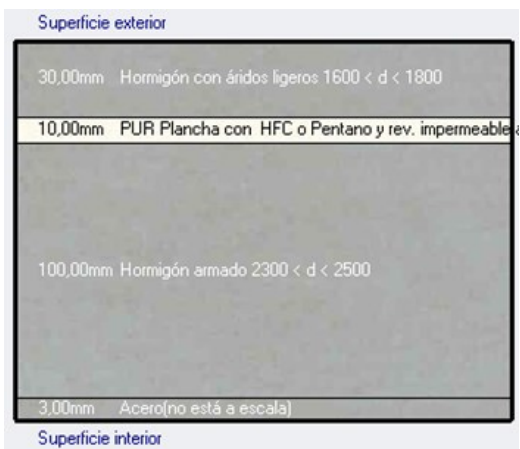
Cubierta en estudio. Tipo Cp-R2-b. Fuente: Design Builder.
